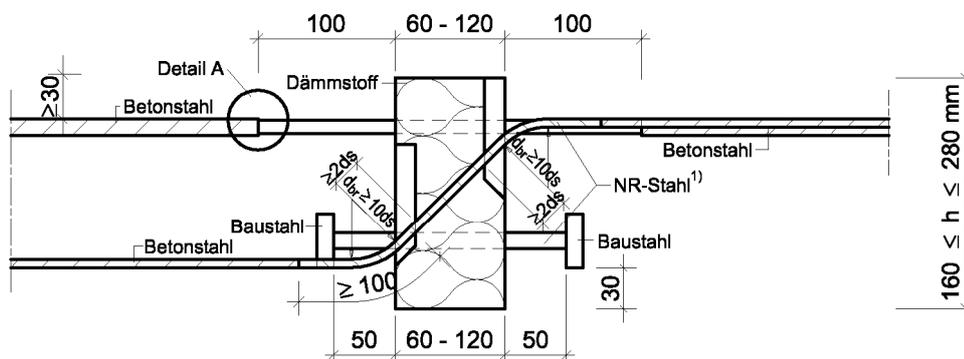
Schöck Isokorb Typ K¹⁾ mit Druck- Querkraft Kombination und abgestuftem Nenndurchmesser der Zugstäbe
